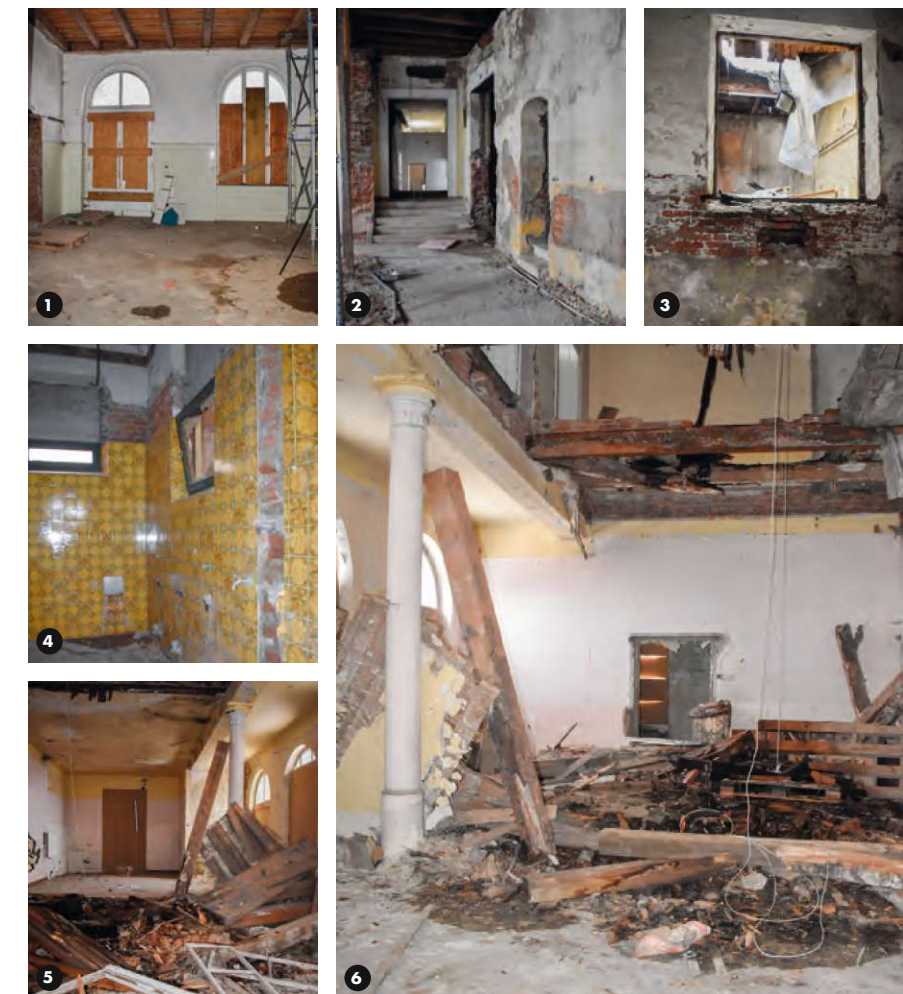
Fotocollage 1-6; Innenraum Erdgeschoss (2021)
